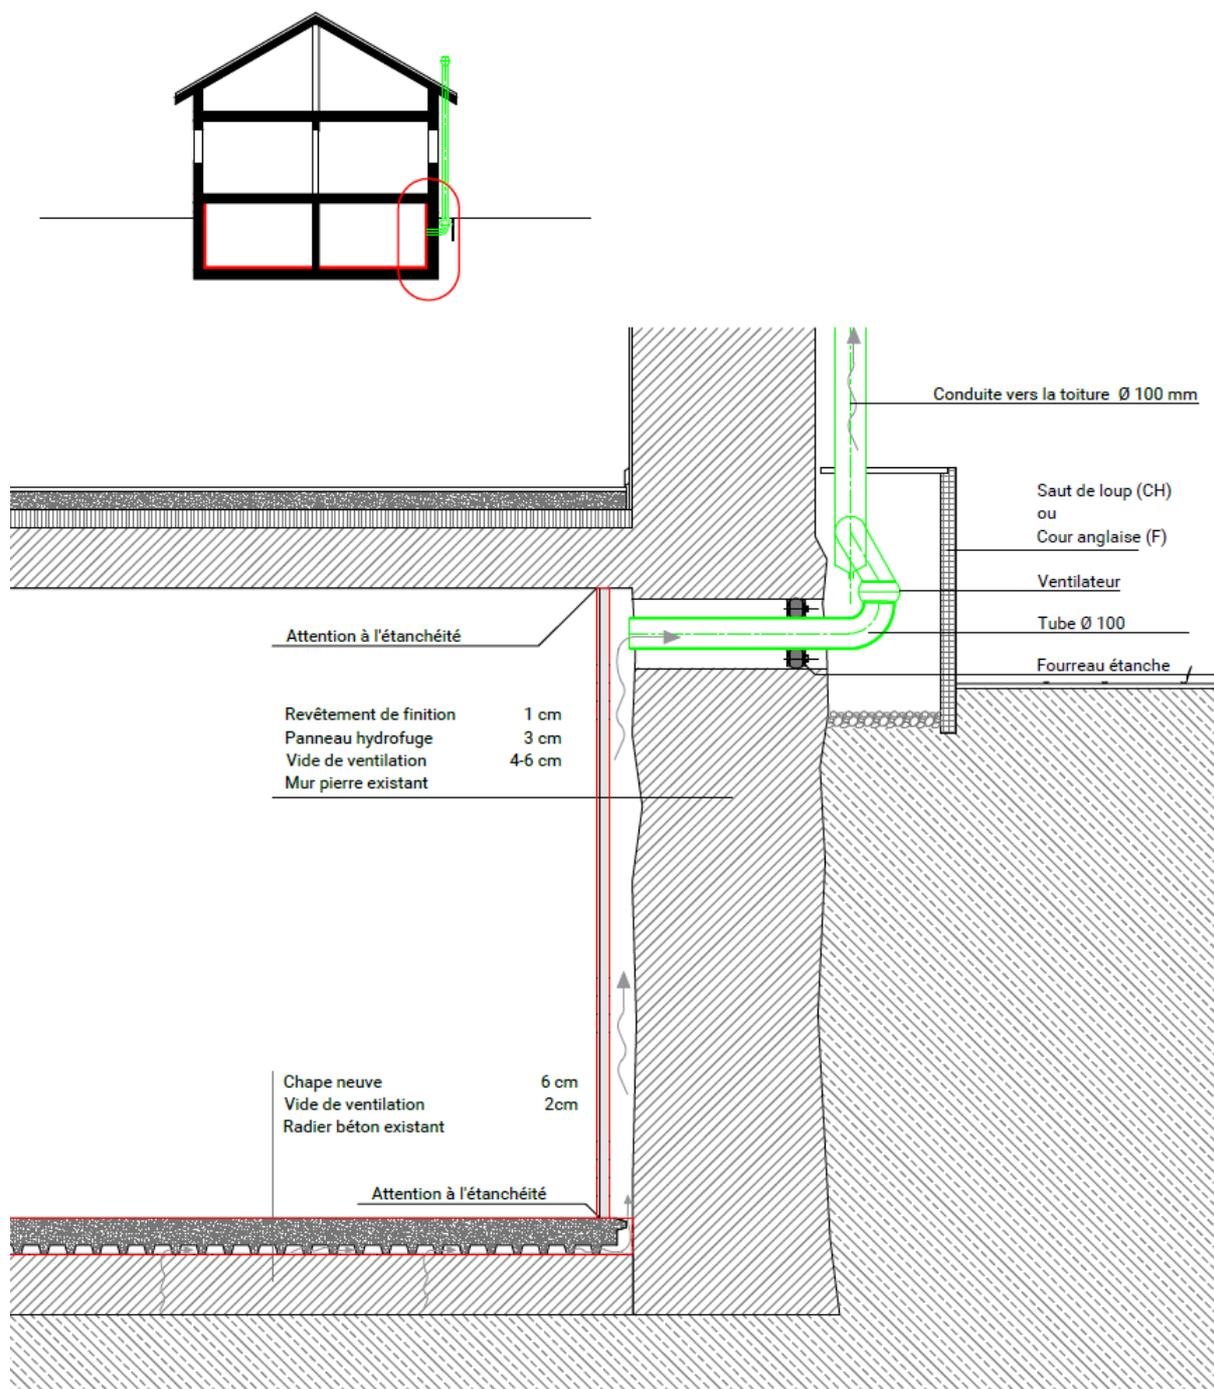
Vue en coupe mur et plancher drainant en rénovation dans une cave (détail : croqAIR, HEIA-FR)
